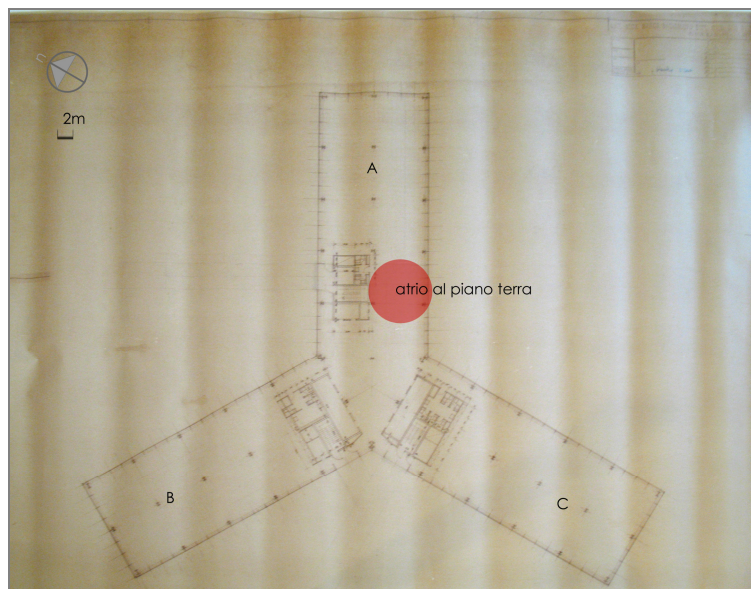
pianta piano tipo (fonte CSAC – archivio n. 234-2, rielaborazione f.m.)
